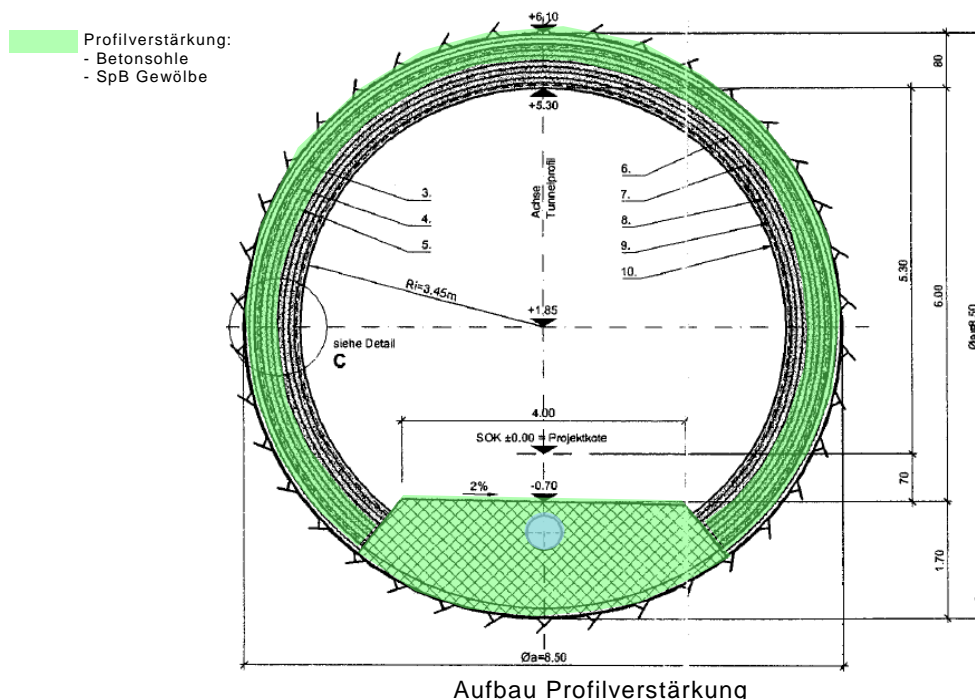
Ausbruchsicherung des Kreisprofils / Einbau Betonsohle
